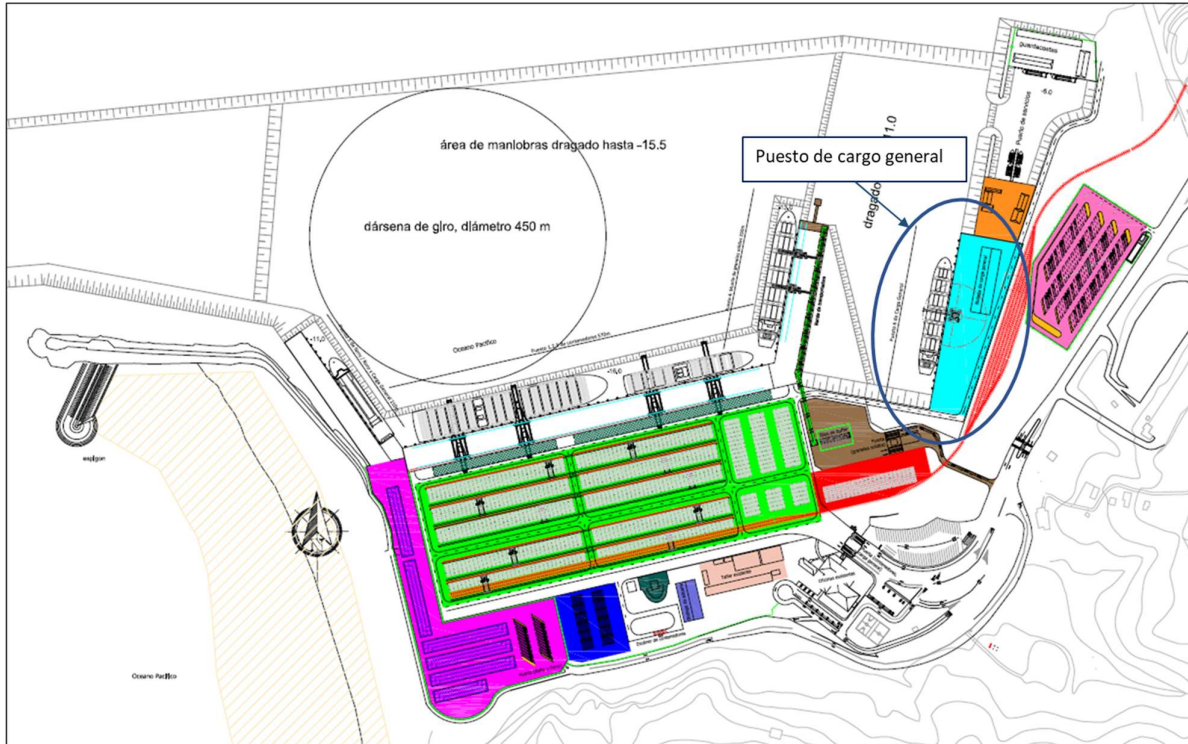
Plan Maestro de puerto Caldera Fase C
